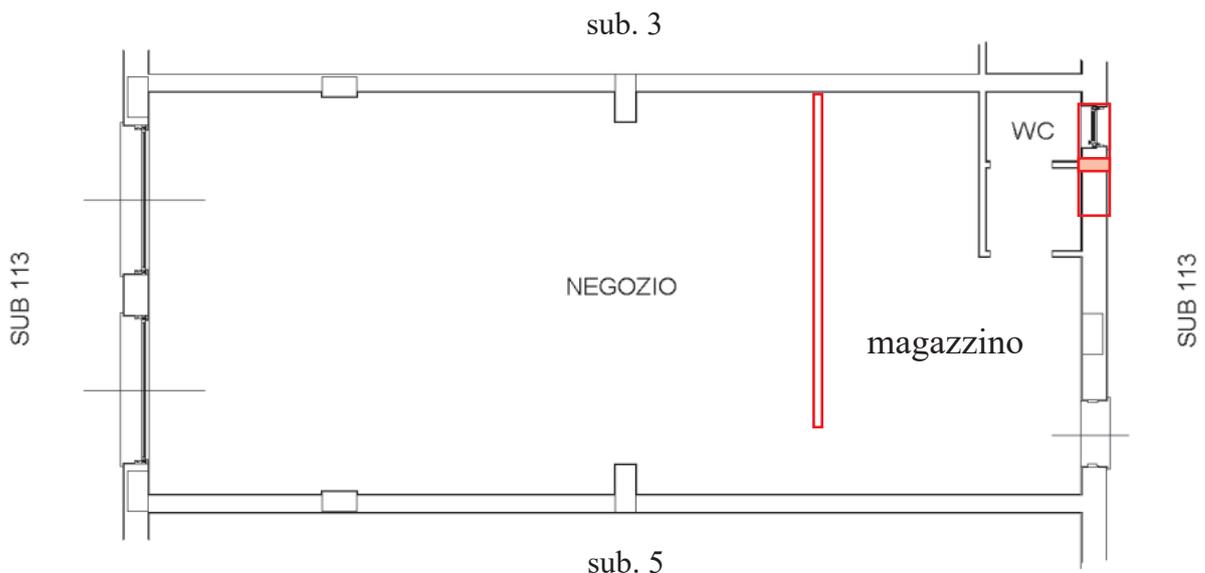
Lotto L6 : Planimetria del locale commerciale sub. 4
